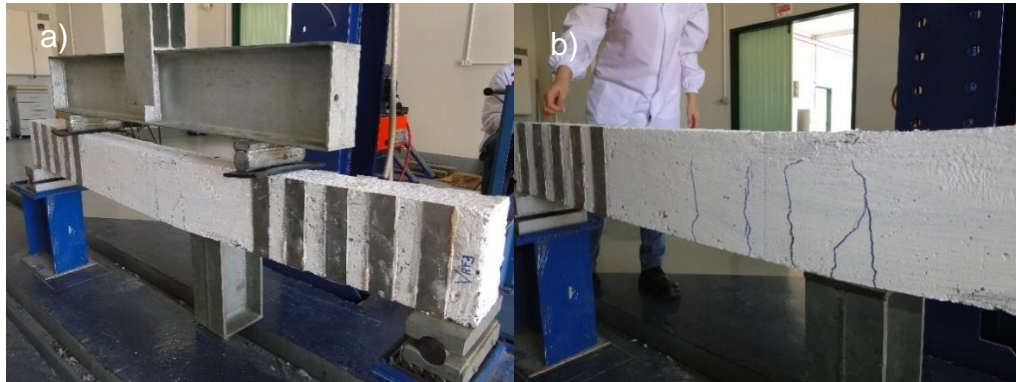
Viga sã reforçada após o ensaio – VRF2. a) Visão geral da viga. b) Detalhe das fissuras.
